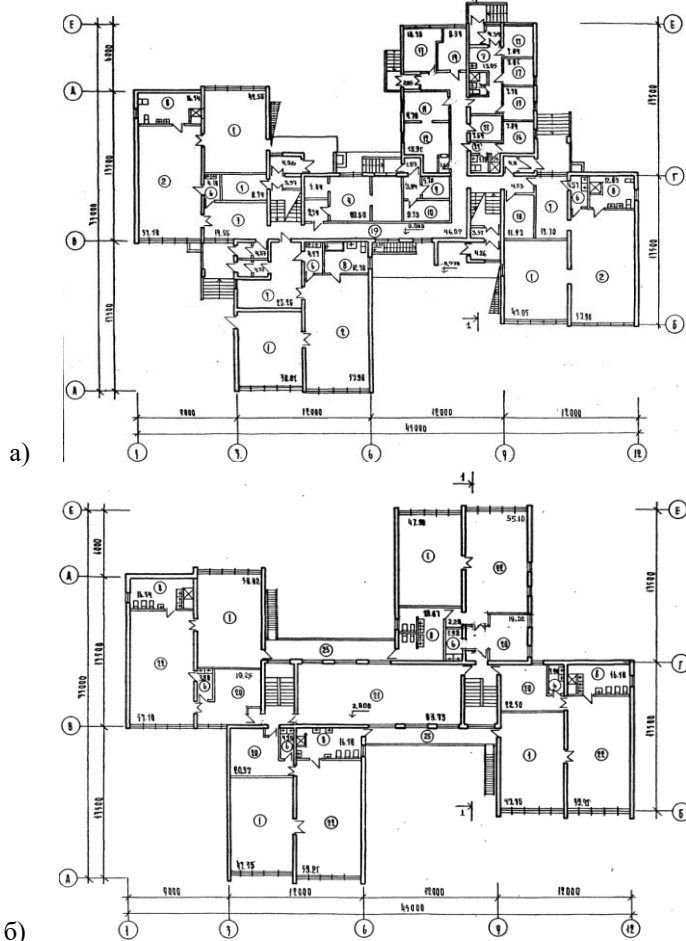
Состав помещений детского сада-яслей на 160 мест: а – план первого этажа; б – план второго этажа
